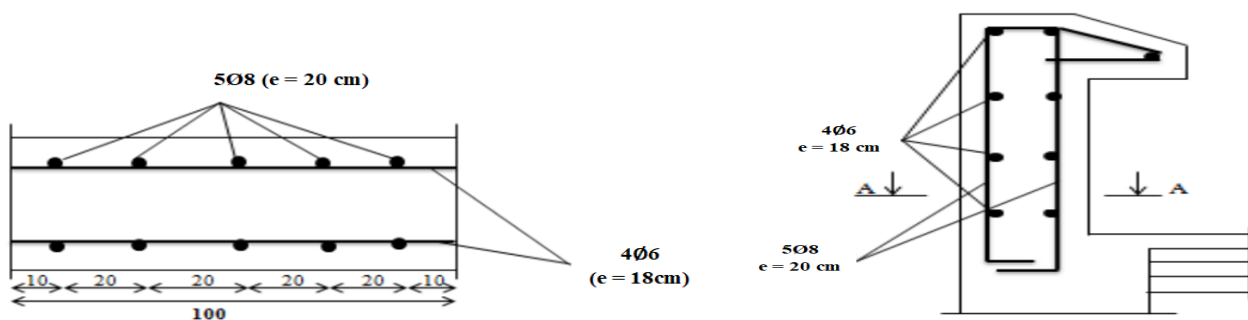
Schéma du ferrailage de l'acrotère.
